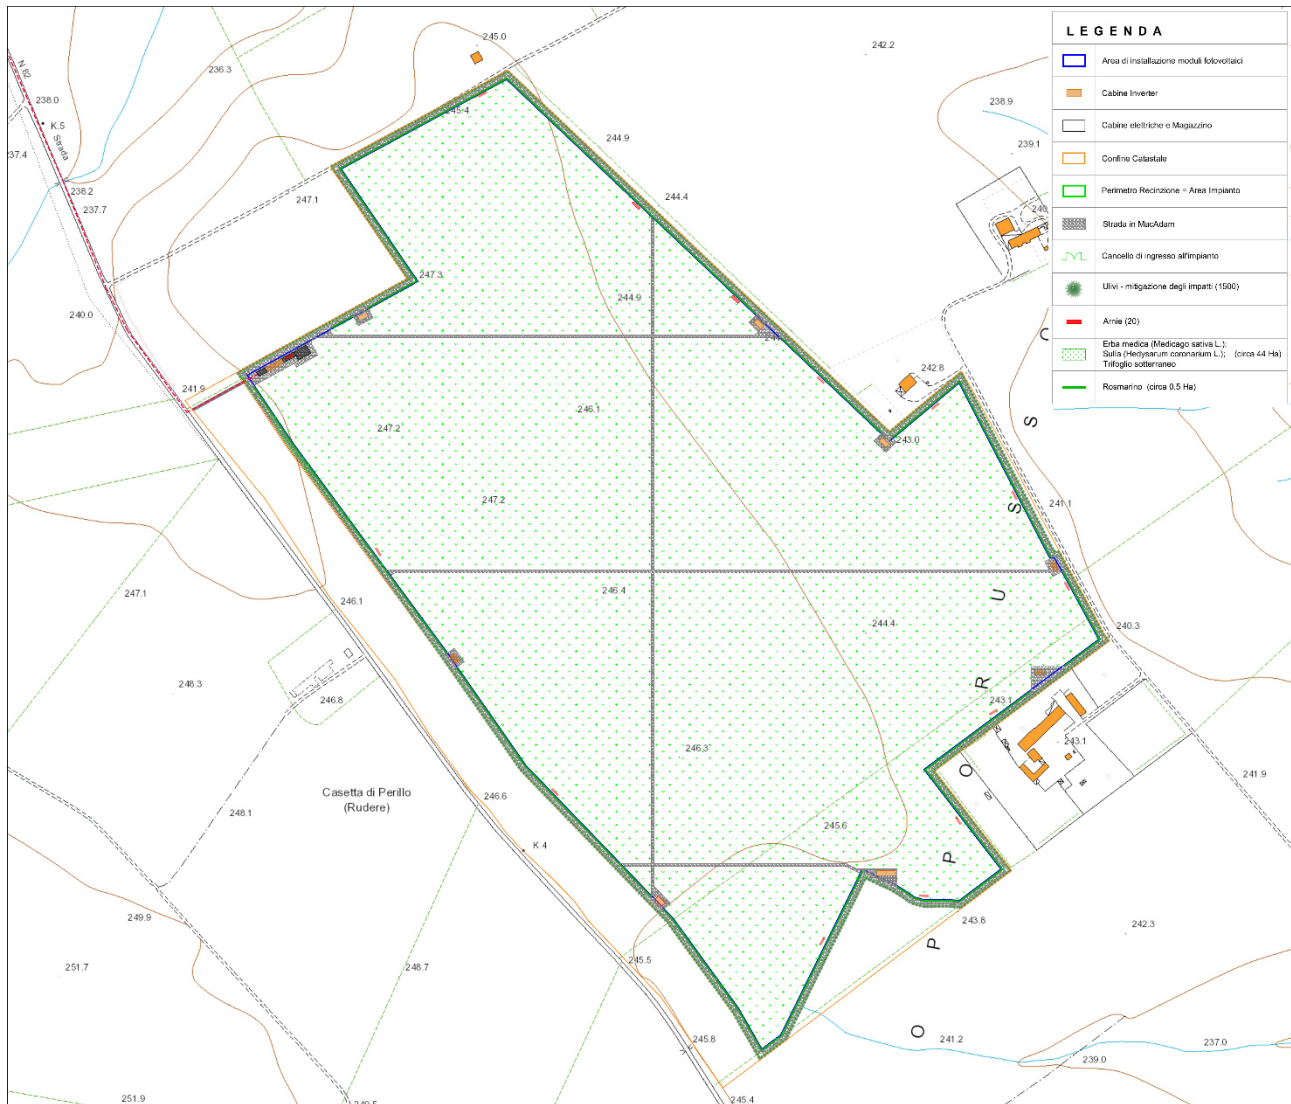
Planimetria interventi di mitigazione ed inerbimento
